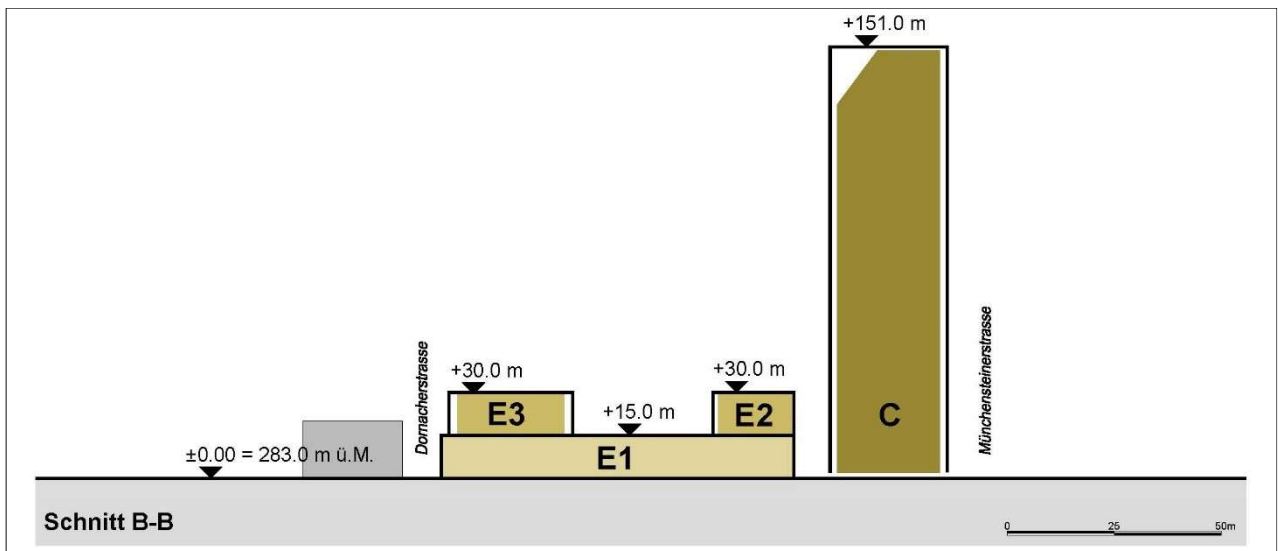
Bebauungsplan Schnitt B-B. (Kein Massstab)
